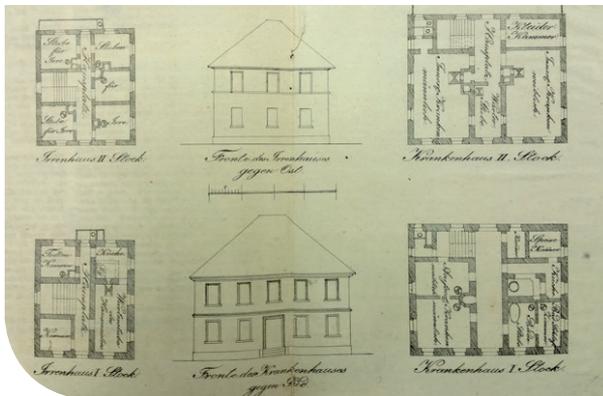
Plan eines einfachen Krankenhauses mit 23 Betten
